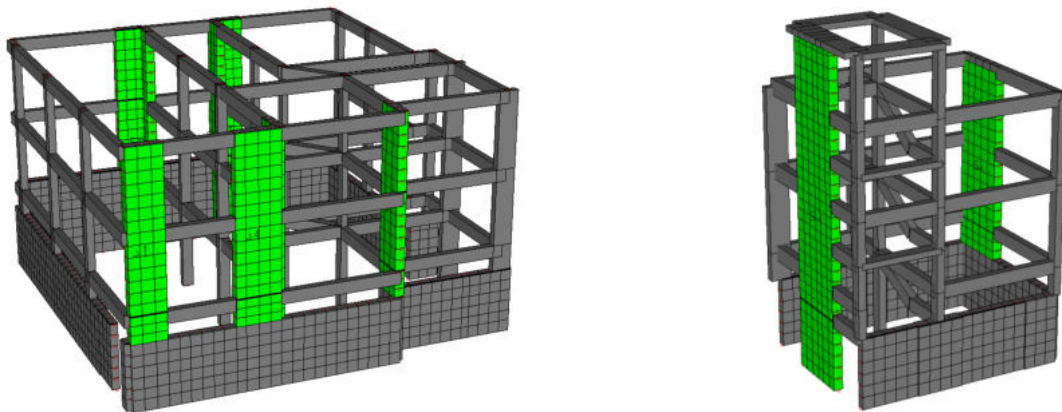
Verifiche statiche a pressoflessione allo SLU: elementi parete in calcestruzzo armato (CORPO GRANDE – CORPO PICCOLO).
